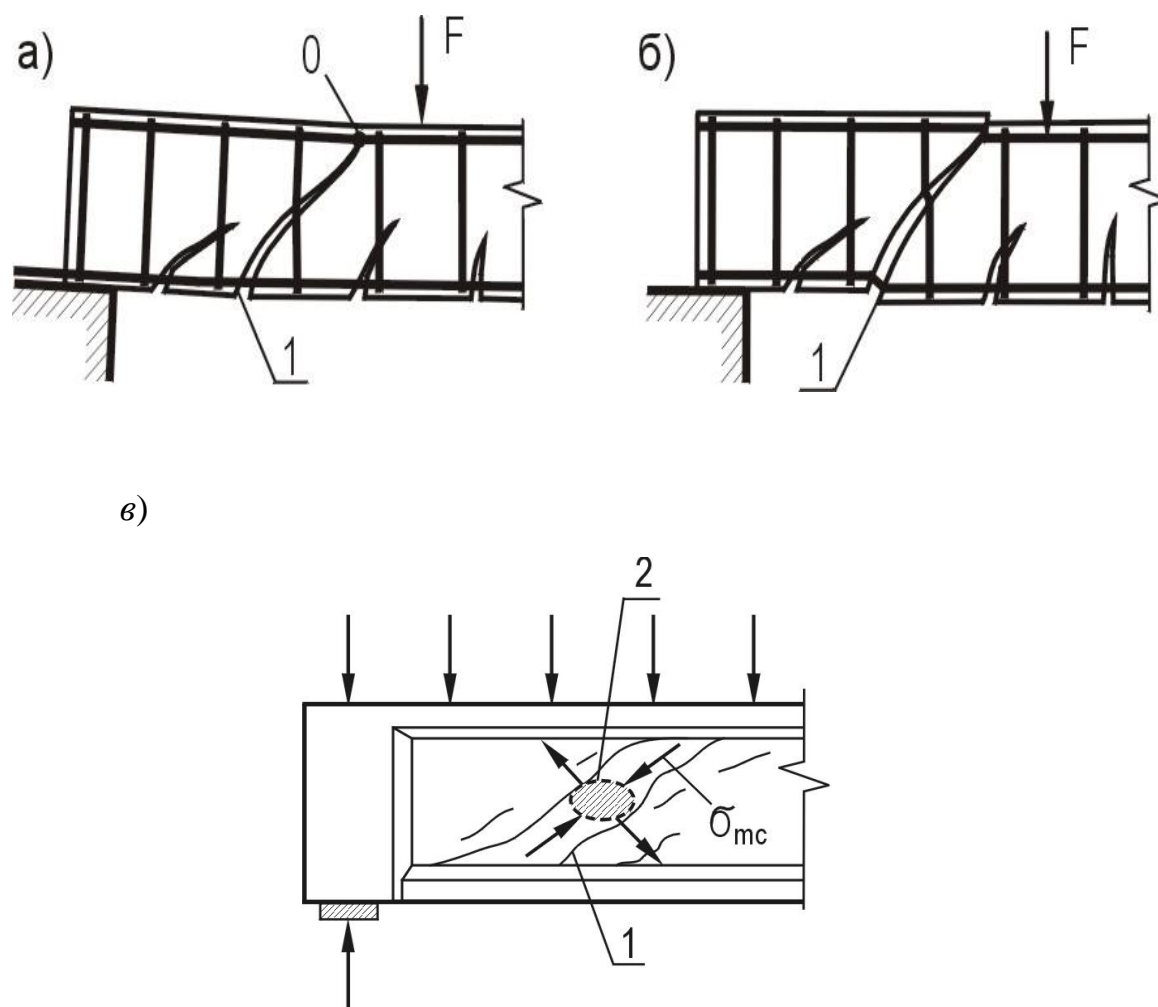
Разрушение изгибаемого элемента по наклонному сечению: 1 – критическая наклонная трещина; «0» – центр тяжести сжатой зоны бетона; 2 – раздавливание бетона.
